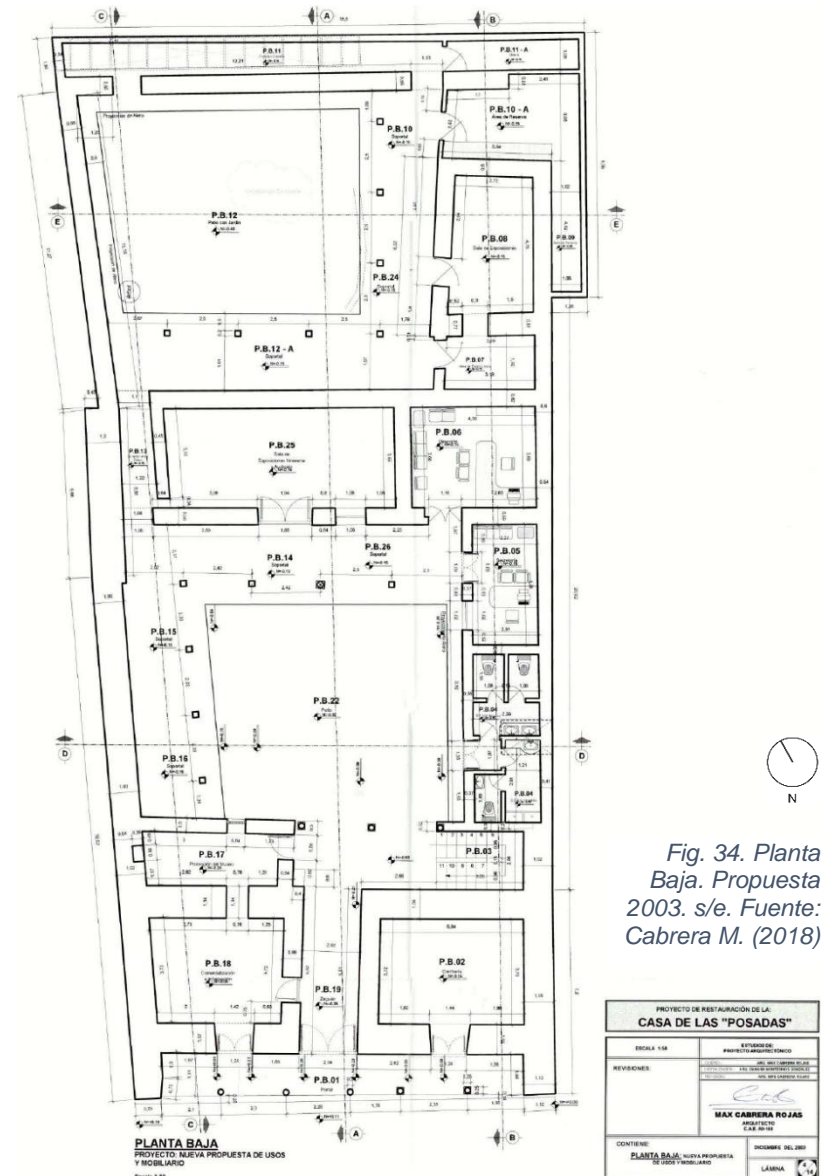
Planta Baja. Propuesta 2003. s/e. Fuente: Cabrera M. (2018)
